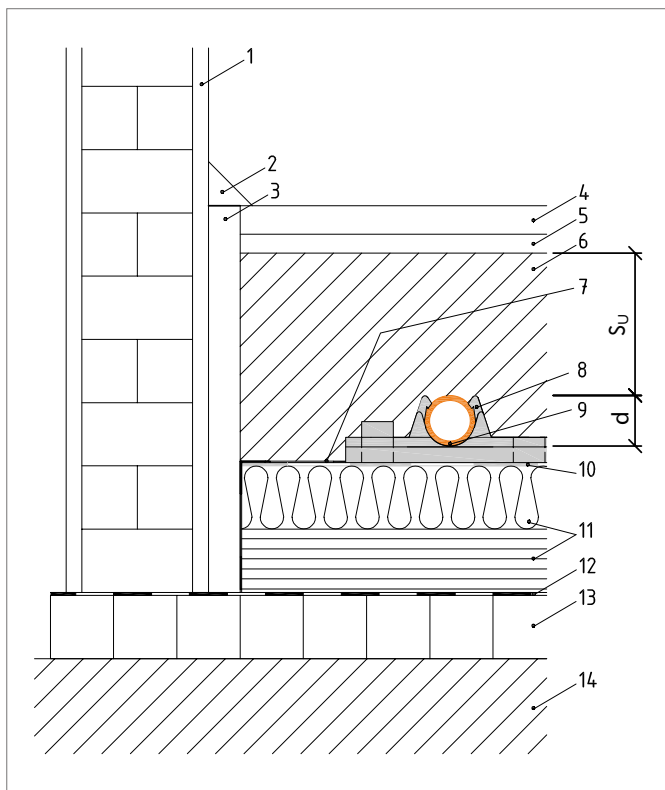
Prinzipaufbau System RAUFIX-Schiene
